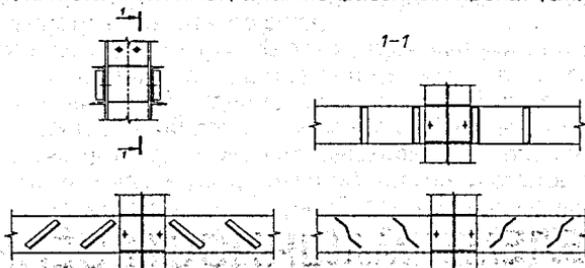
Конструкции объединения внешнего армирования с железобетонной частью ригелей.
